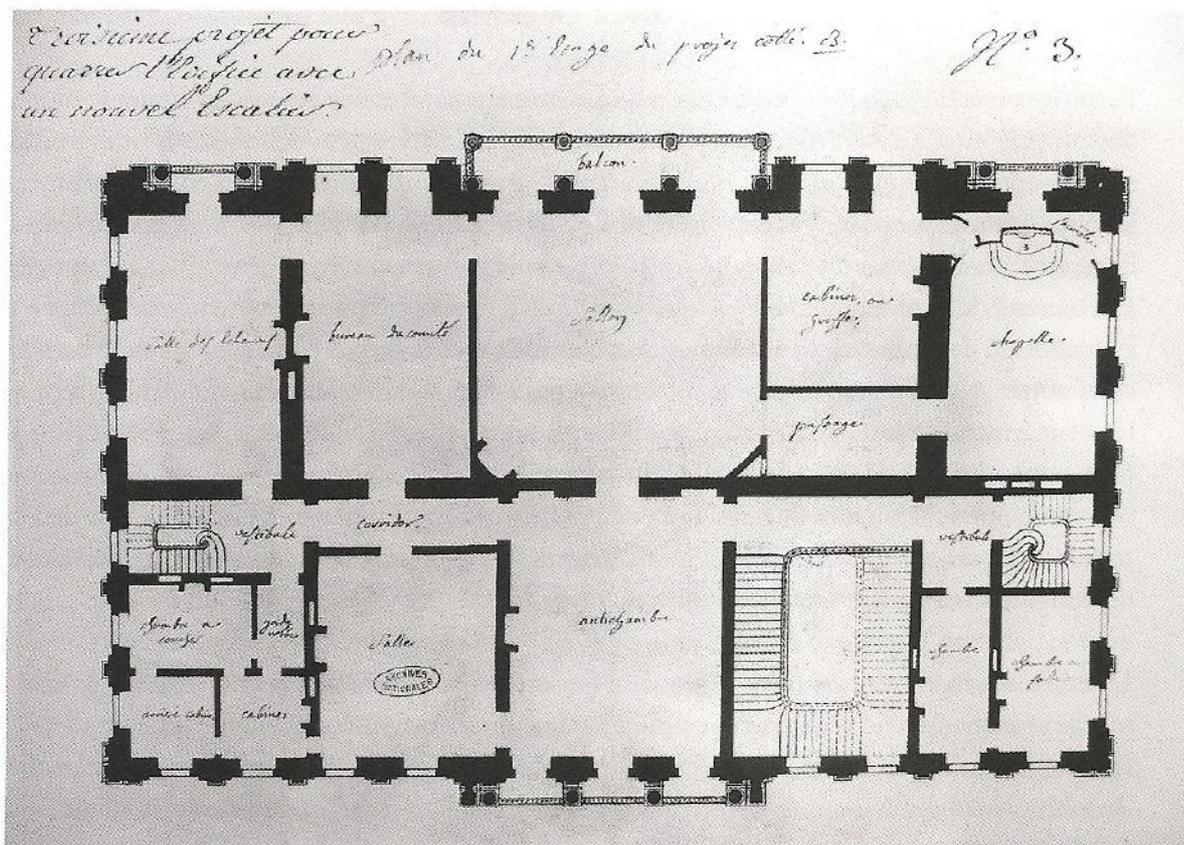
> Mansart de Sagonne : variante au premier étage du troisième projet avec escalier latéral, 1748 [© AN, Cartes et plans].
